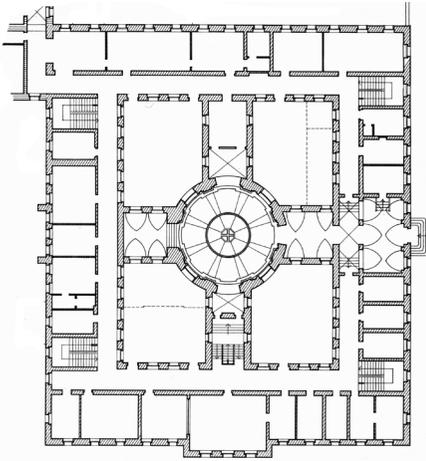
Fribourg, Hôpital des bourgeois, plan du rez-de-chaussée (1681-1699) (tiré de: MAH FR).
